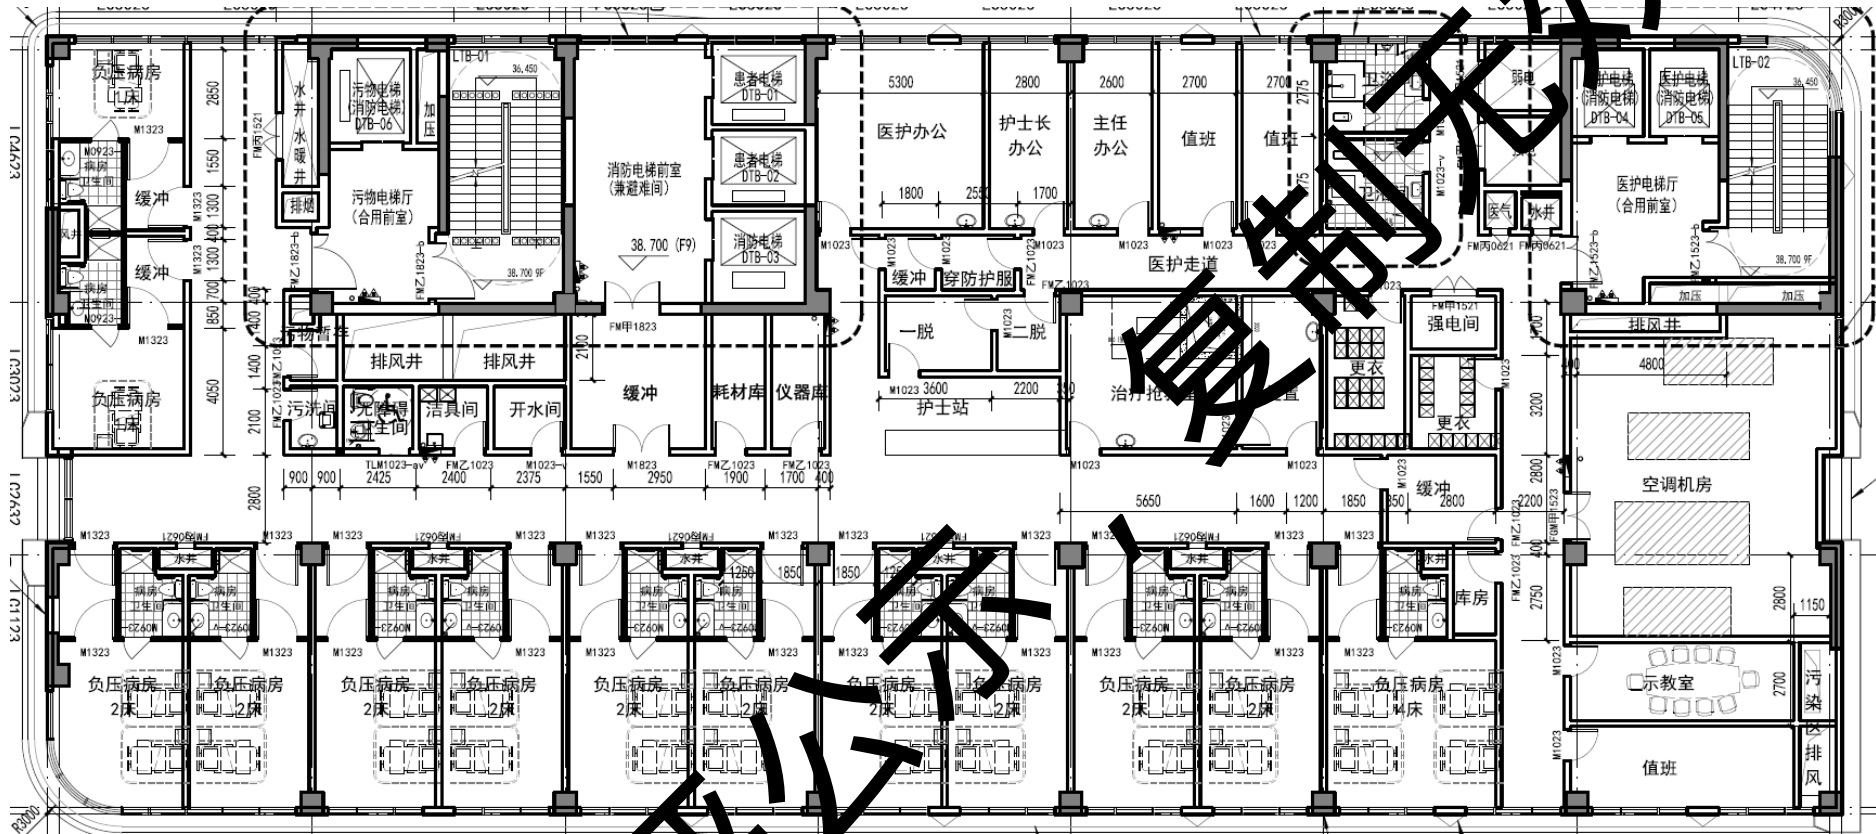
本项目新建应急中心楼 9F 平面布置图
